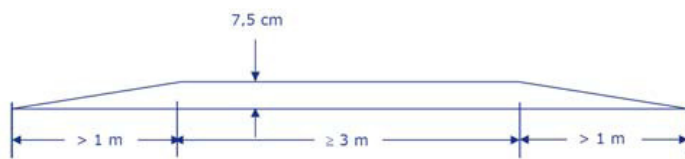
Pormenores de dimensionamento de lomba/perfil trapezoidal (DGV, 2004)
